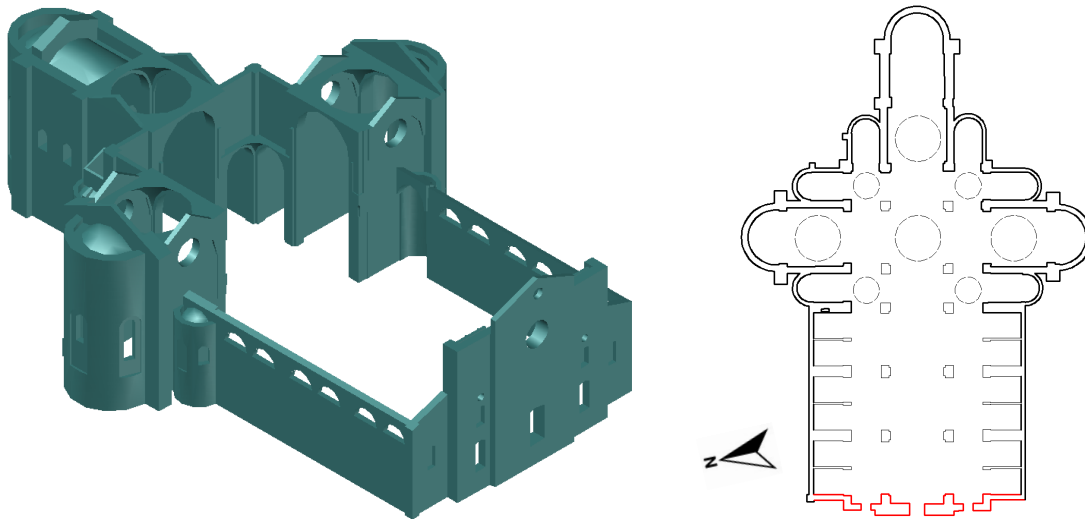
Vista assonometrica e pianta della fase 3 della struttura.
